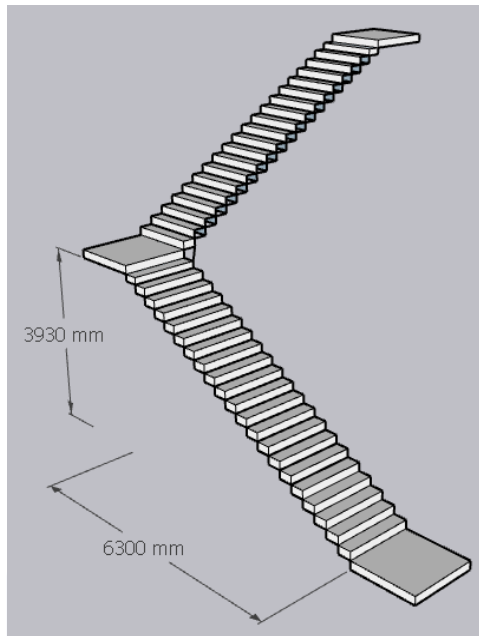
Gambar Ilustrasi Tangga di Bangunan B
